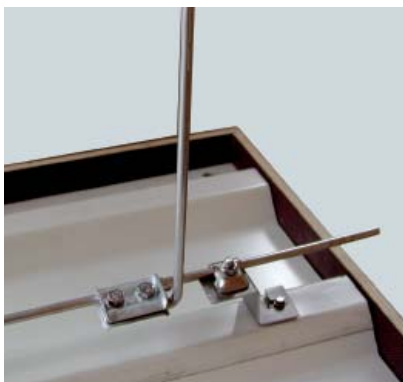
Musteraufbau Trapezblech-Dach, Leitungshalter mit Klemmbock
